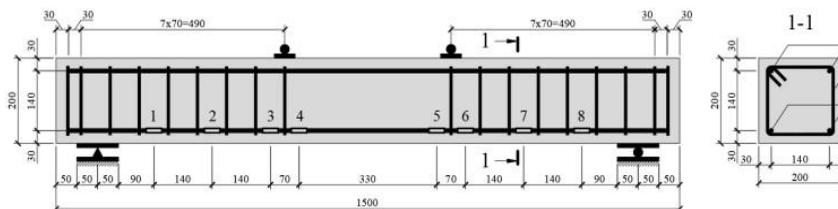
Геометрические характеристики железобетонной балки со схемой расположения арматурной стали
